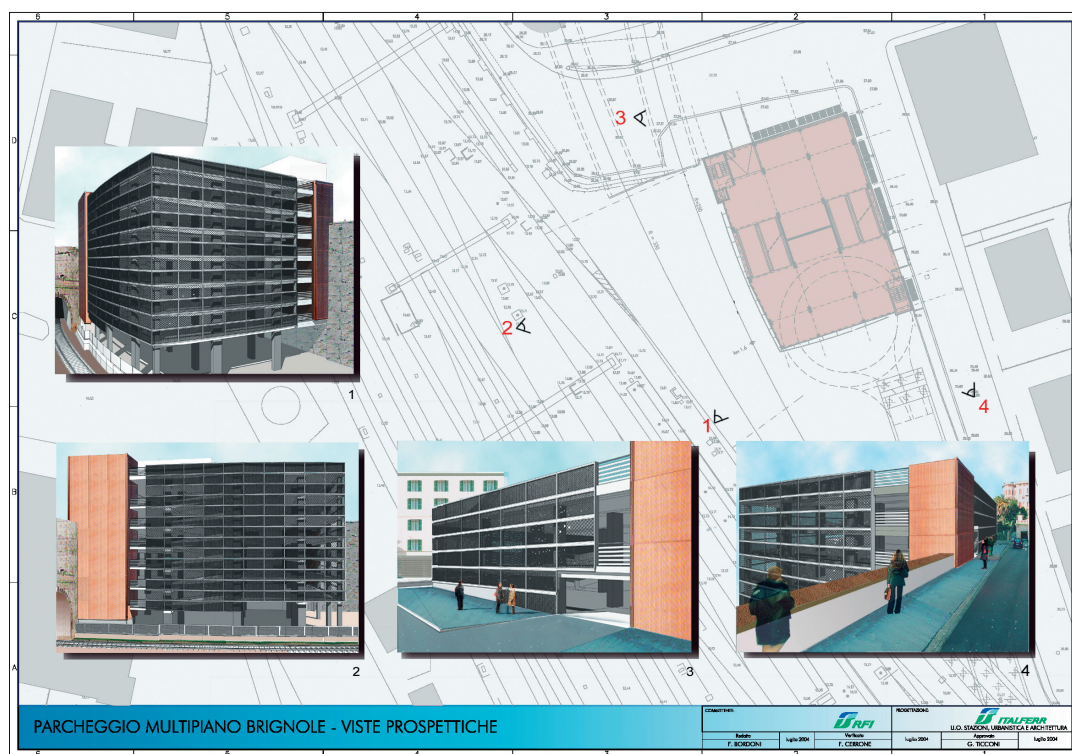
Parcheggio multipiano presso la stazione di Genova Brignole: rendering delle viste prospettiche.
